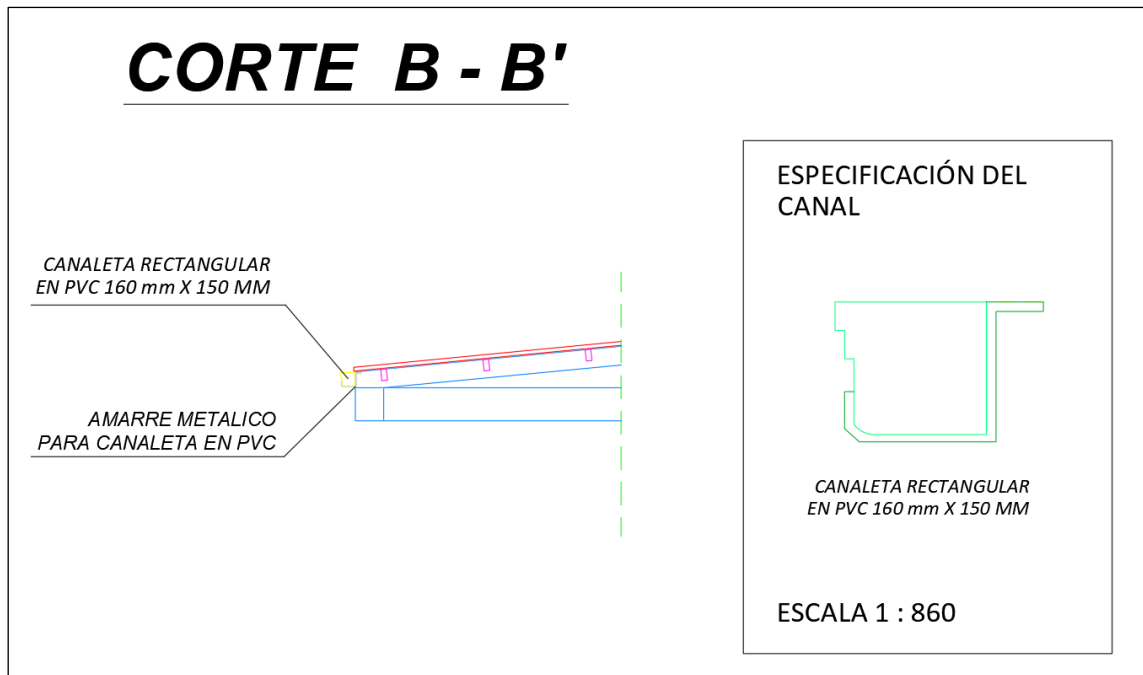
Corte arquitectónico B-B', de la estructura 4 del Centro de Desarrollo Infantil.
